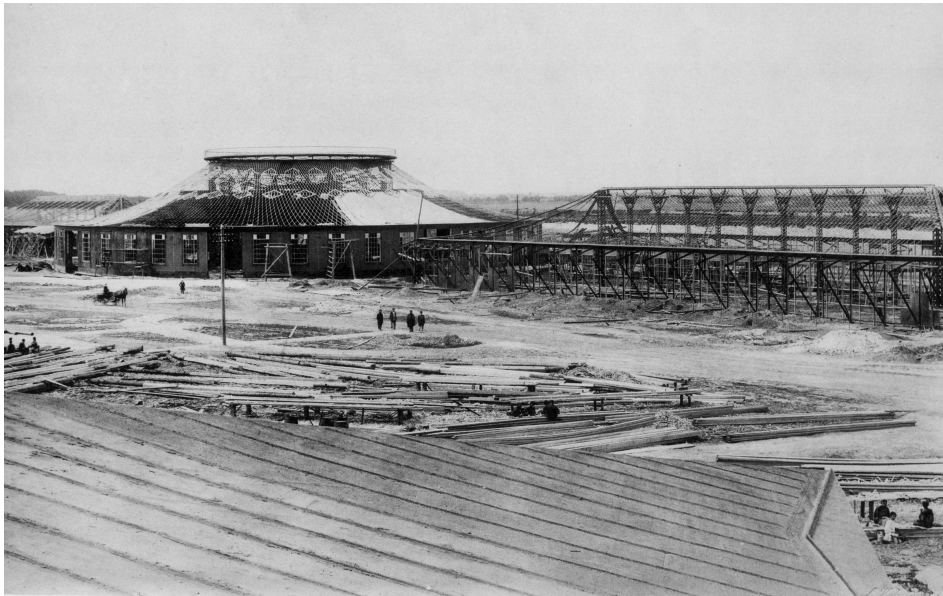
Vista general del Pabellón Rotonda y los Pabellones Longitudinales en construcción, Vladimir Shukov, 1896
